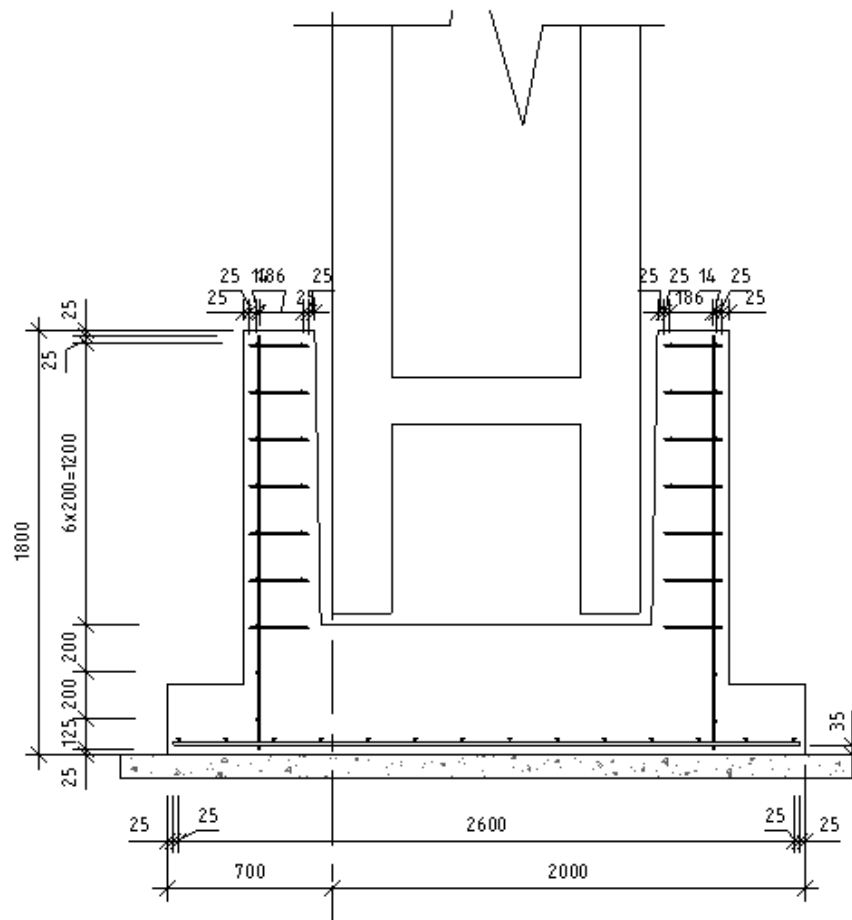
Схема армування фундаменту ФМ-1.
